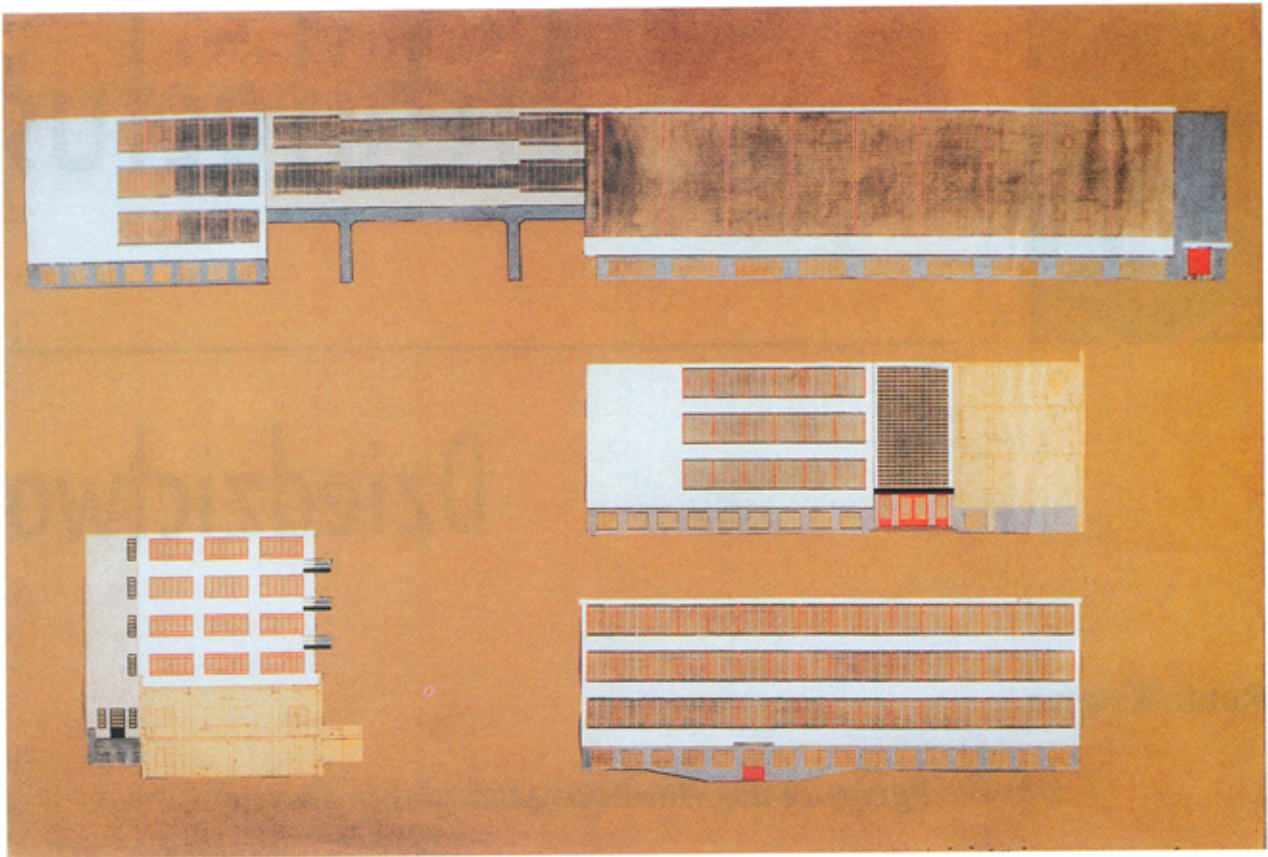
Hinnerk Scheper, Farbplan des Bauhausgebäudes, Fassaden, 1926
